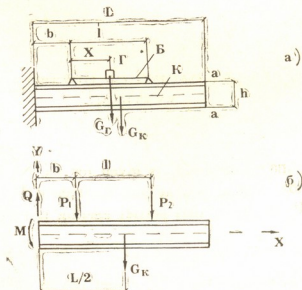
К определению наименьшего веса груза, вызывающего разрушение железобетонной консоли
